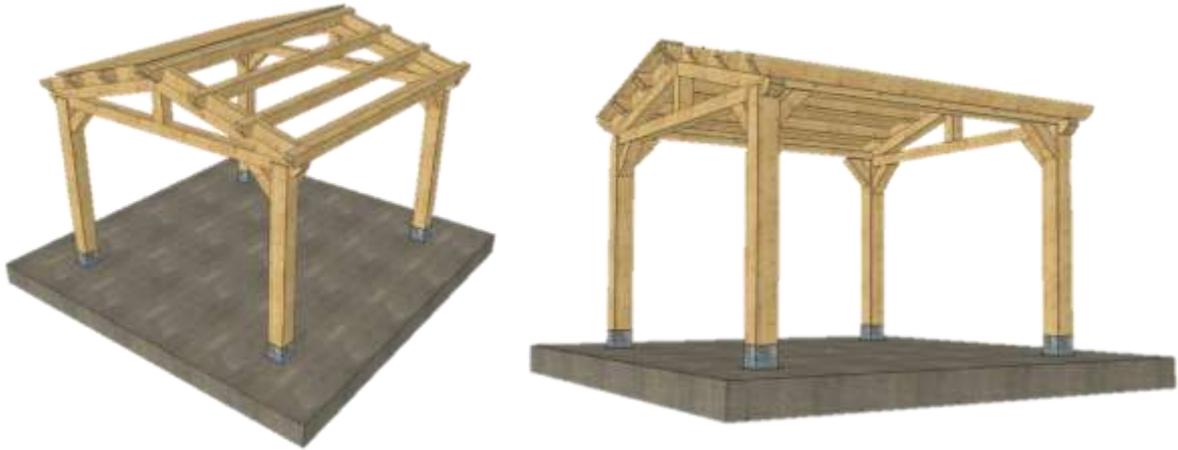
Croquis de la estructura de madera. Fuente Elaboración propia
